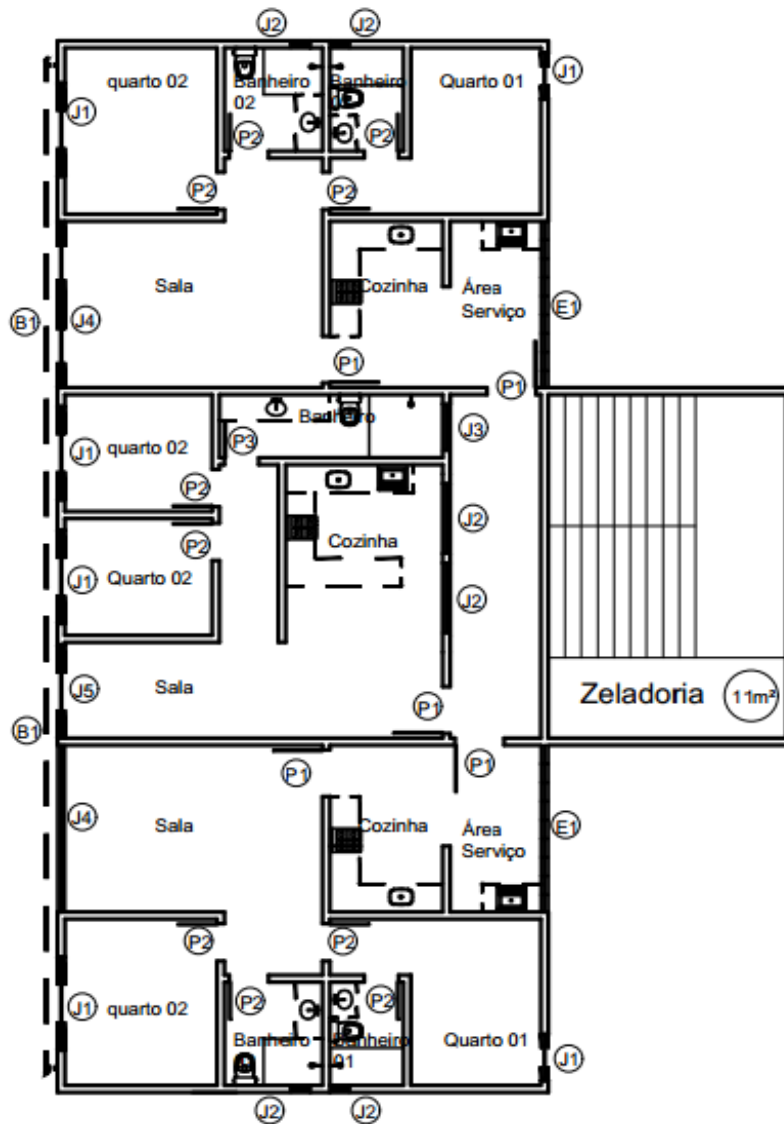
Planta baixa do pavimento tipo da edificação em estudo
